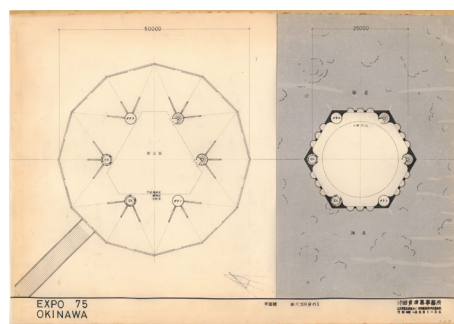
EXPO'75 OKINAWA 平面図 (7-33-78)
